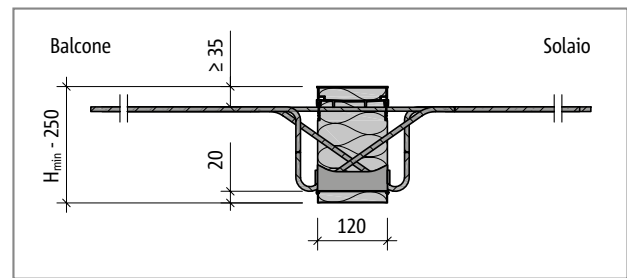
Schöck Isokorb® tipo KXT45-VV: sezione dell'elemento
